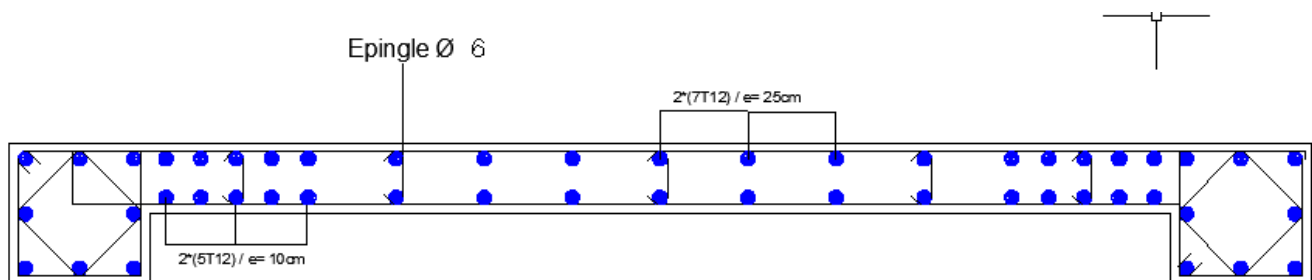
Disposition des armatures verticale dans les voiles.
